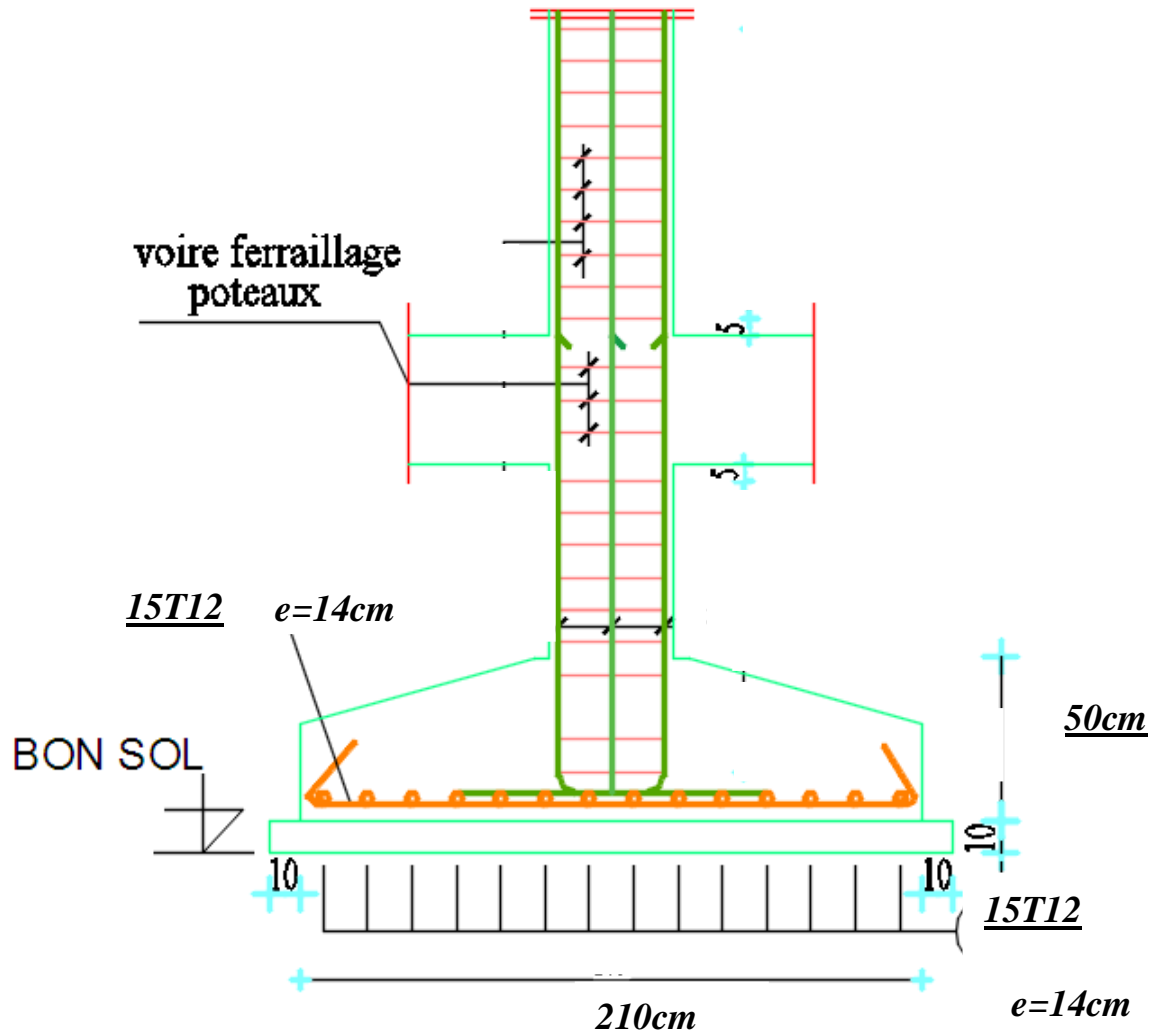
schéma de ferrailage semelle isolée sous poteau de rive
